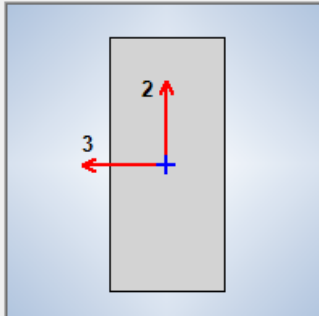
Chiclayo, Viga de 40\*90, 2020.
